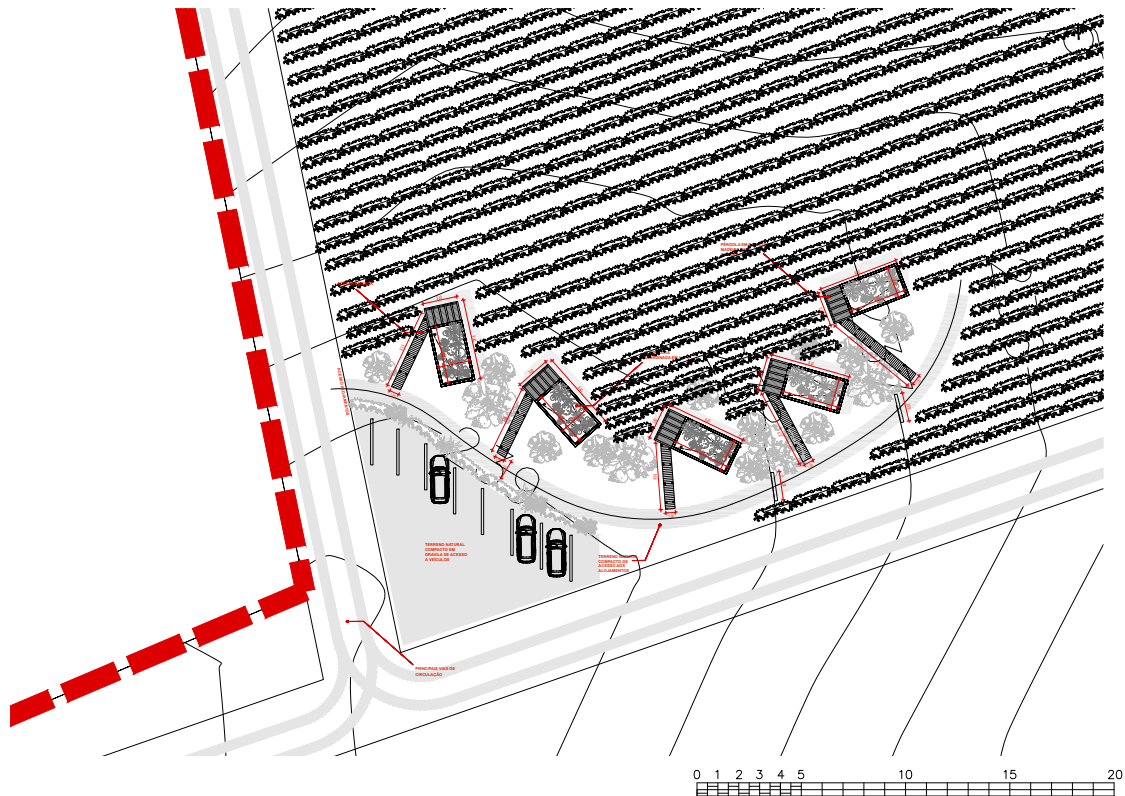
Planta de Implantação e respetiva Planta de Cobertura Proposta Esc. 1:200
